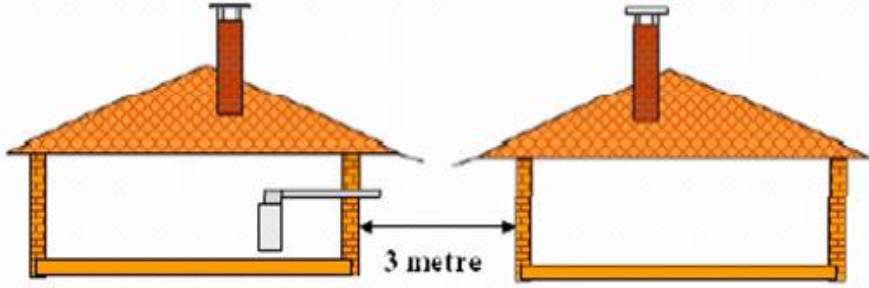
Hermetik kombi bacası montaj mesafeleri
